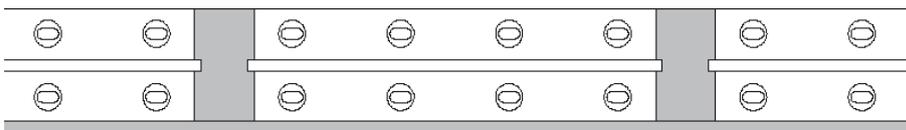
Kreuzrippendecke X-Floor – Schnitt¹³⁹
